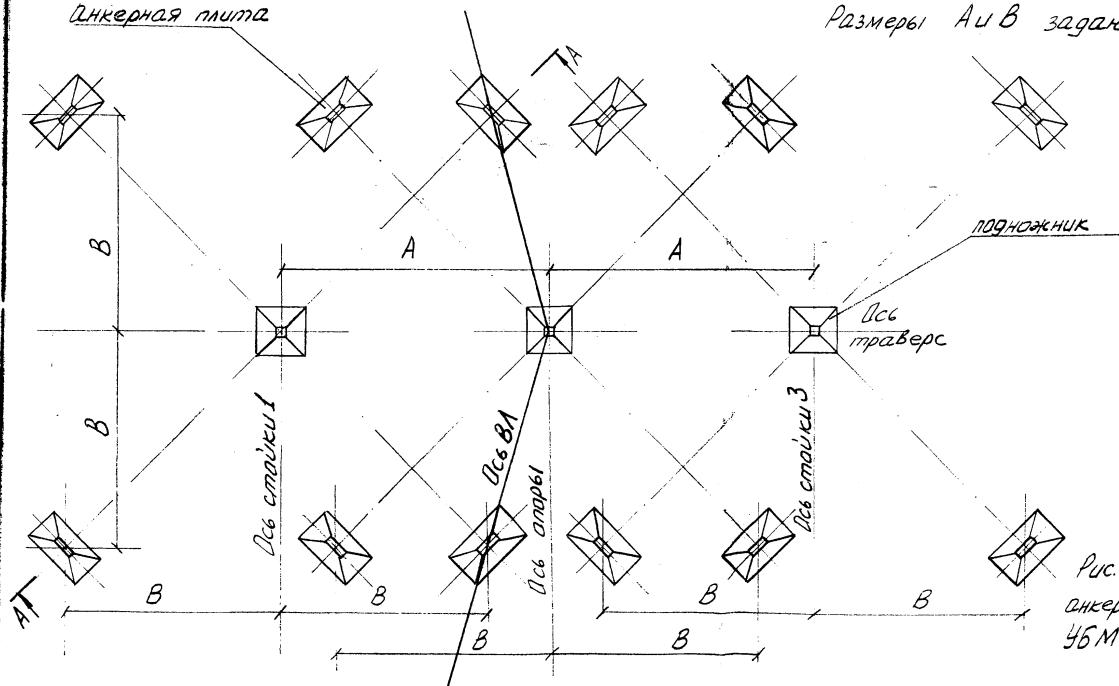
Схема фундаментов под анкерно-угловые опоры ЧБМ-17 и ЧБМ-22.
